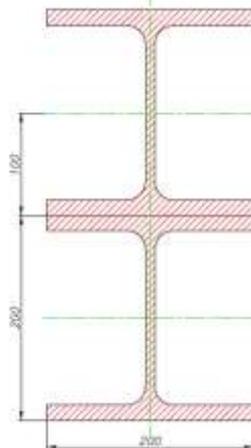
Sección transversal de la columna. Fuente: (Autor)
